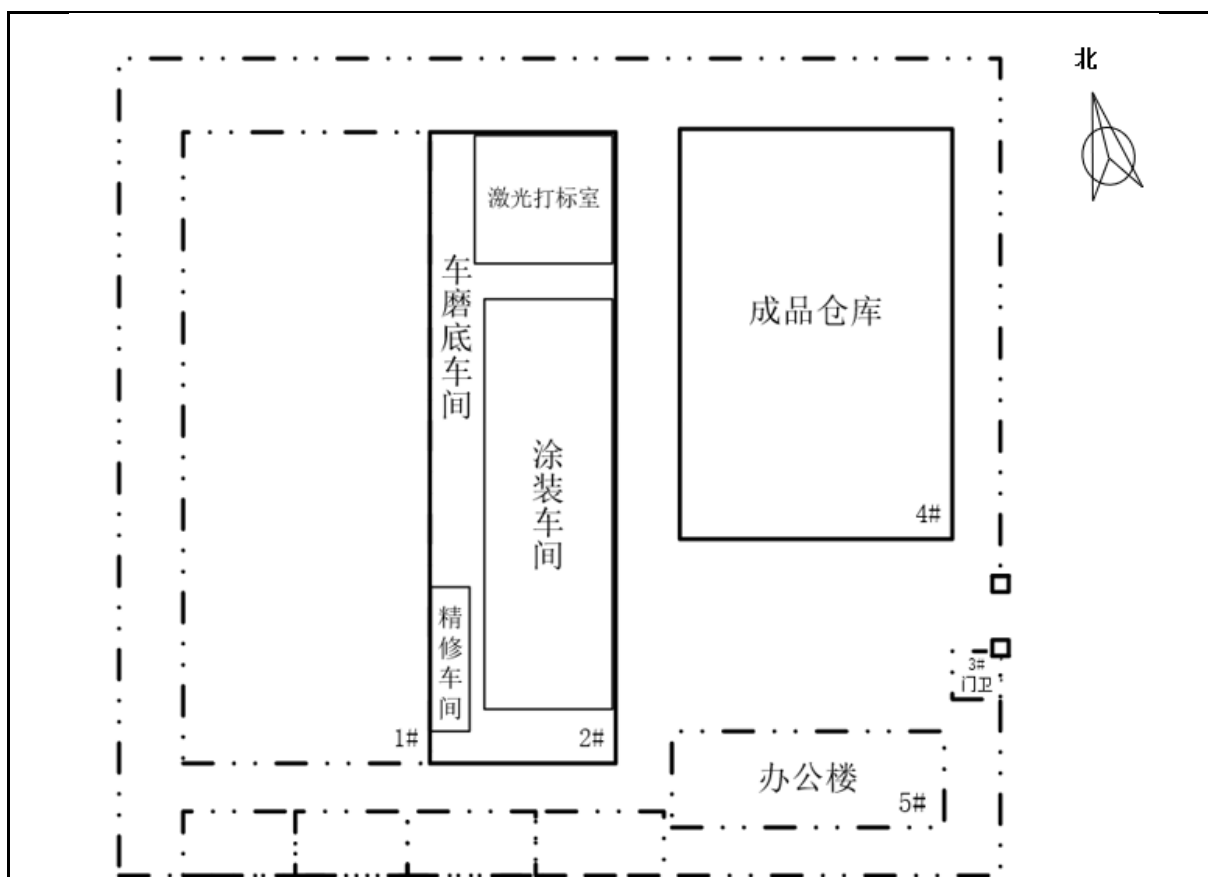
厂区平面布置图（2#车间、4#车间 3F）
